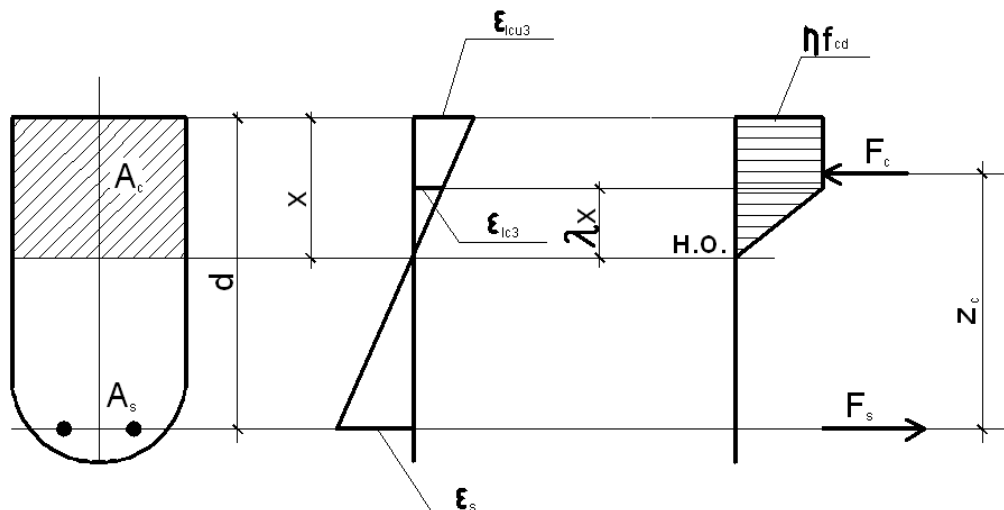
Трапециевидное распределение напряжений по высоте эффективной сжатой зоны бетона нормального сечения
